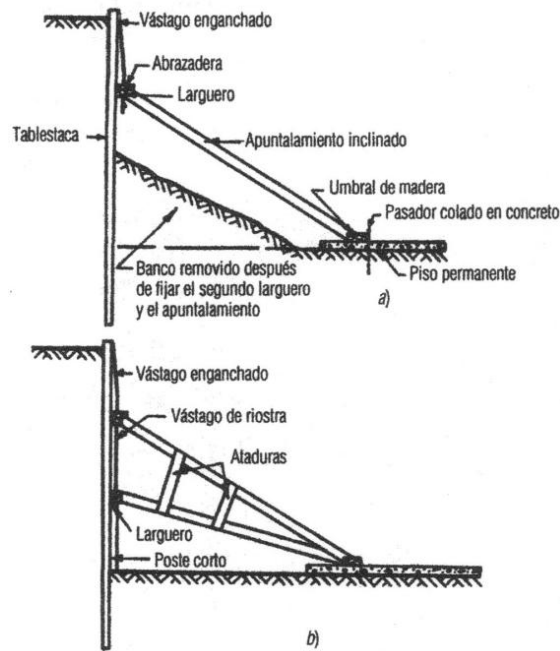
Soporte con tablestacas y apuntalamientos enfilados. a) Primera etapa de la excavación. b) Segunda etapa de la excavación (Tomlinson, 2008).
